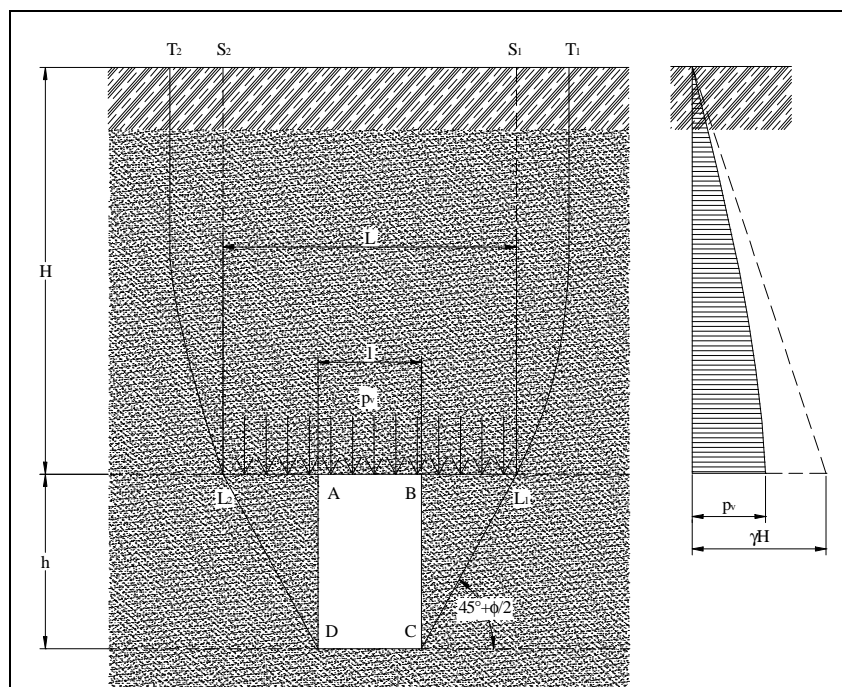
Determinazione della massa spingente sul cielo e sui piedritti del tunnel
